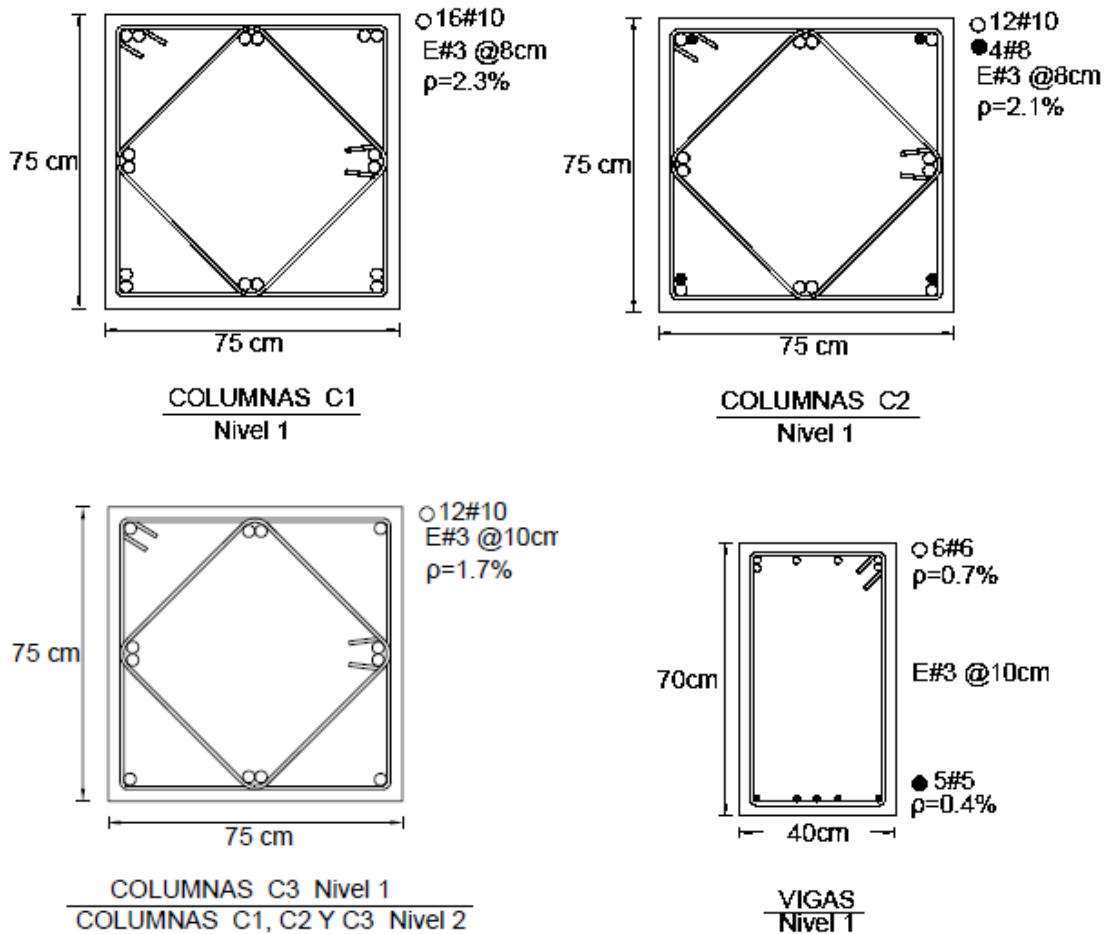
Armado de vigas y columnas diseñadas con las NTCC-04 para el edificio de 8 niveles con un sistema estructural a base de marcos dúctiles y muros diafragma
